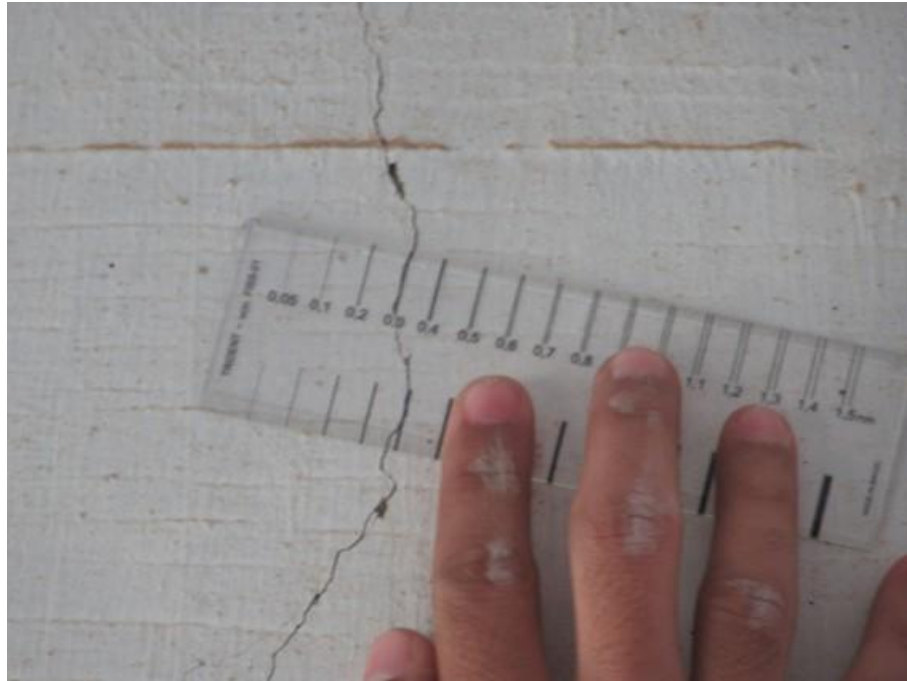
(IMG_0932) Viga transversina 4 – face norte – abertura de fissura 0,3mm.
